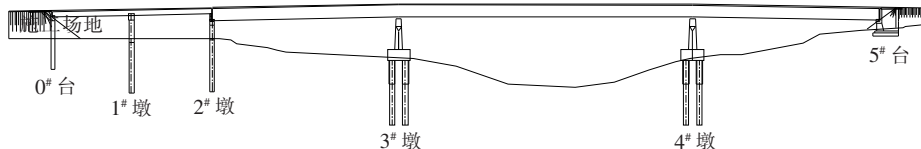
主桥顶推施工关键步骤示意(第 6~9 步)(单位:mm)
